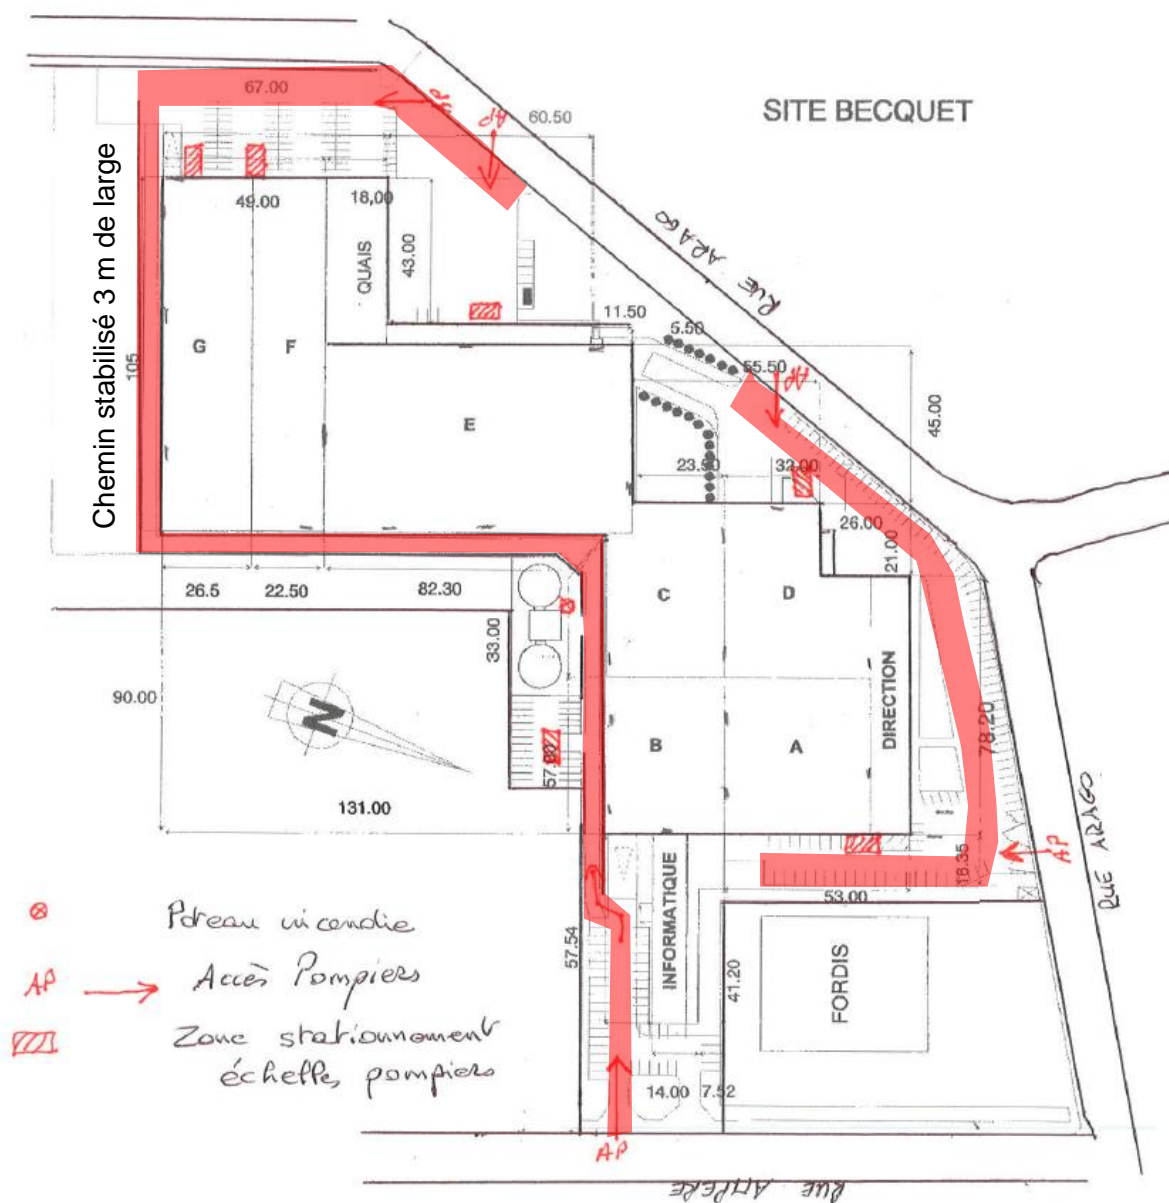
Plan accessibilité voie engin et stationnement échelle
